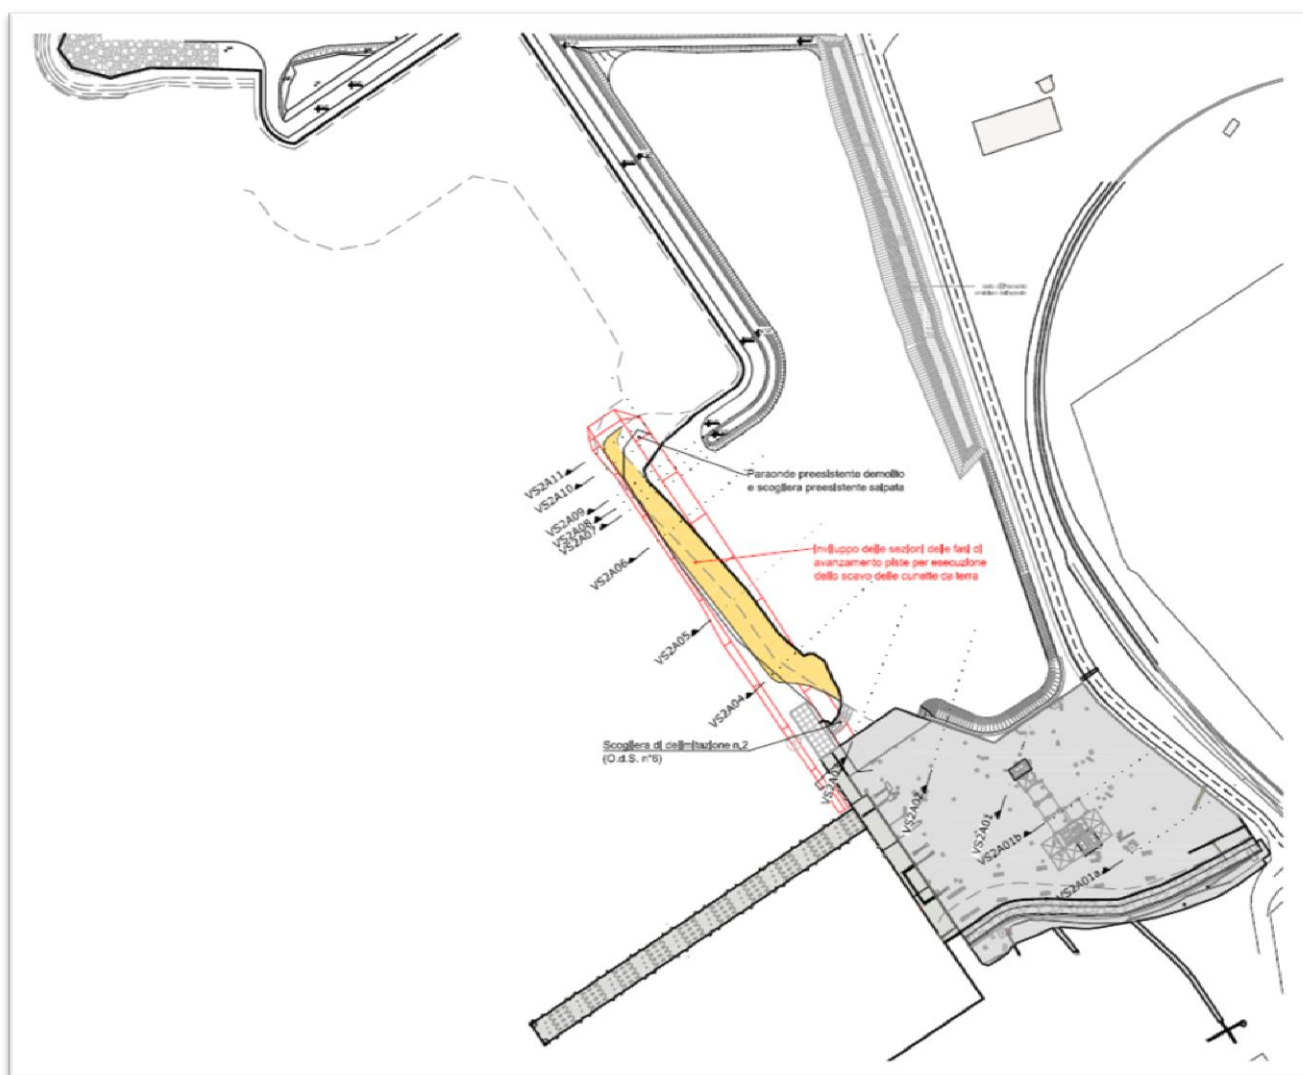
Stralcio planimetria scavo da terra della cunetta tra le sezione CDT 13-30
